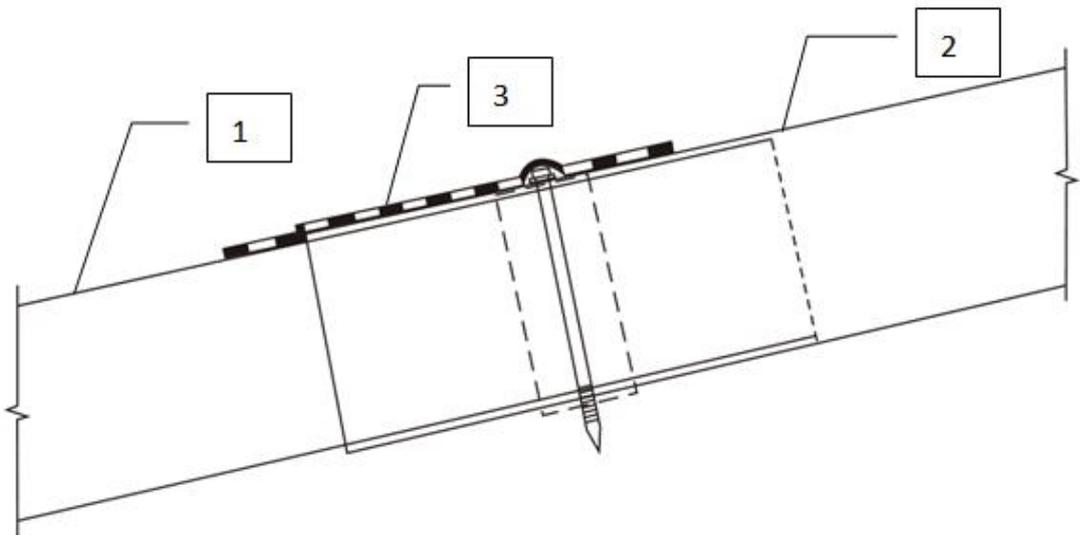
金属屋面板搭接竖缝防水结构示意图
